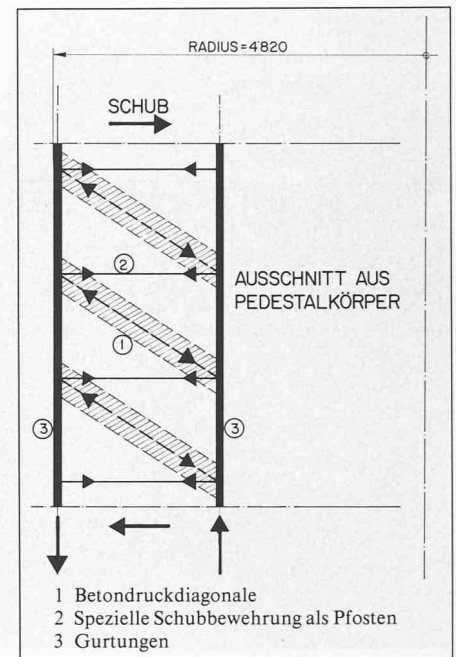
Schematische Darstellung der Wirkung der Schubbewehrung im Ersatzfachwerk
